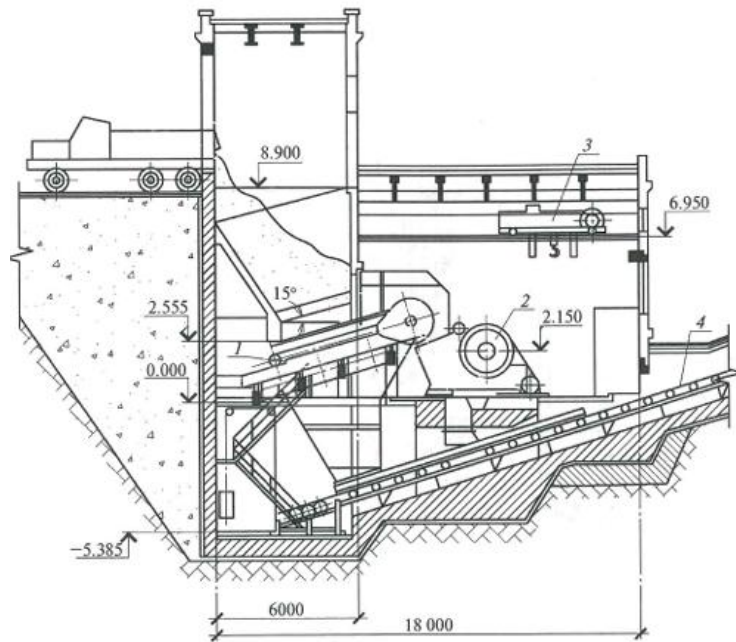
Корпус крупного дроблення зі щоквою дробаркою:
